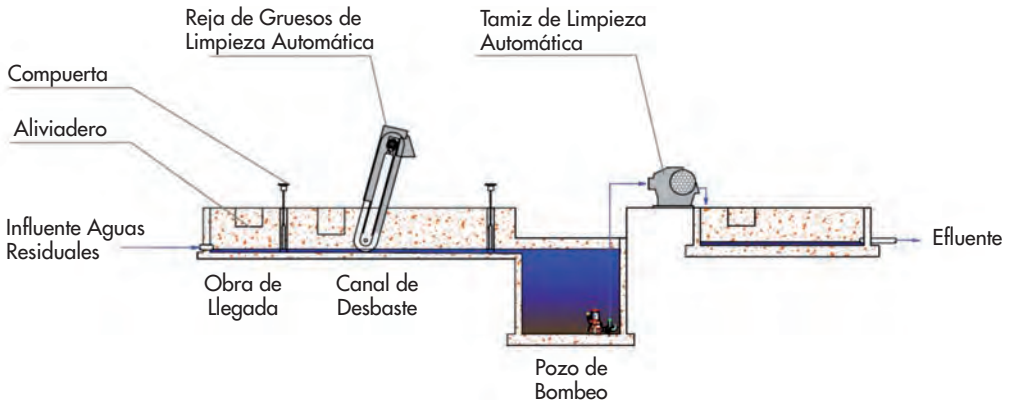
Planta de pretratamiento con desbaste y desarenado-desengrasado de limpieza automática
